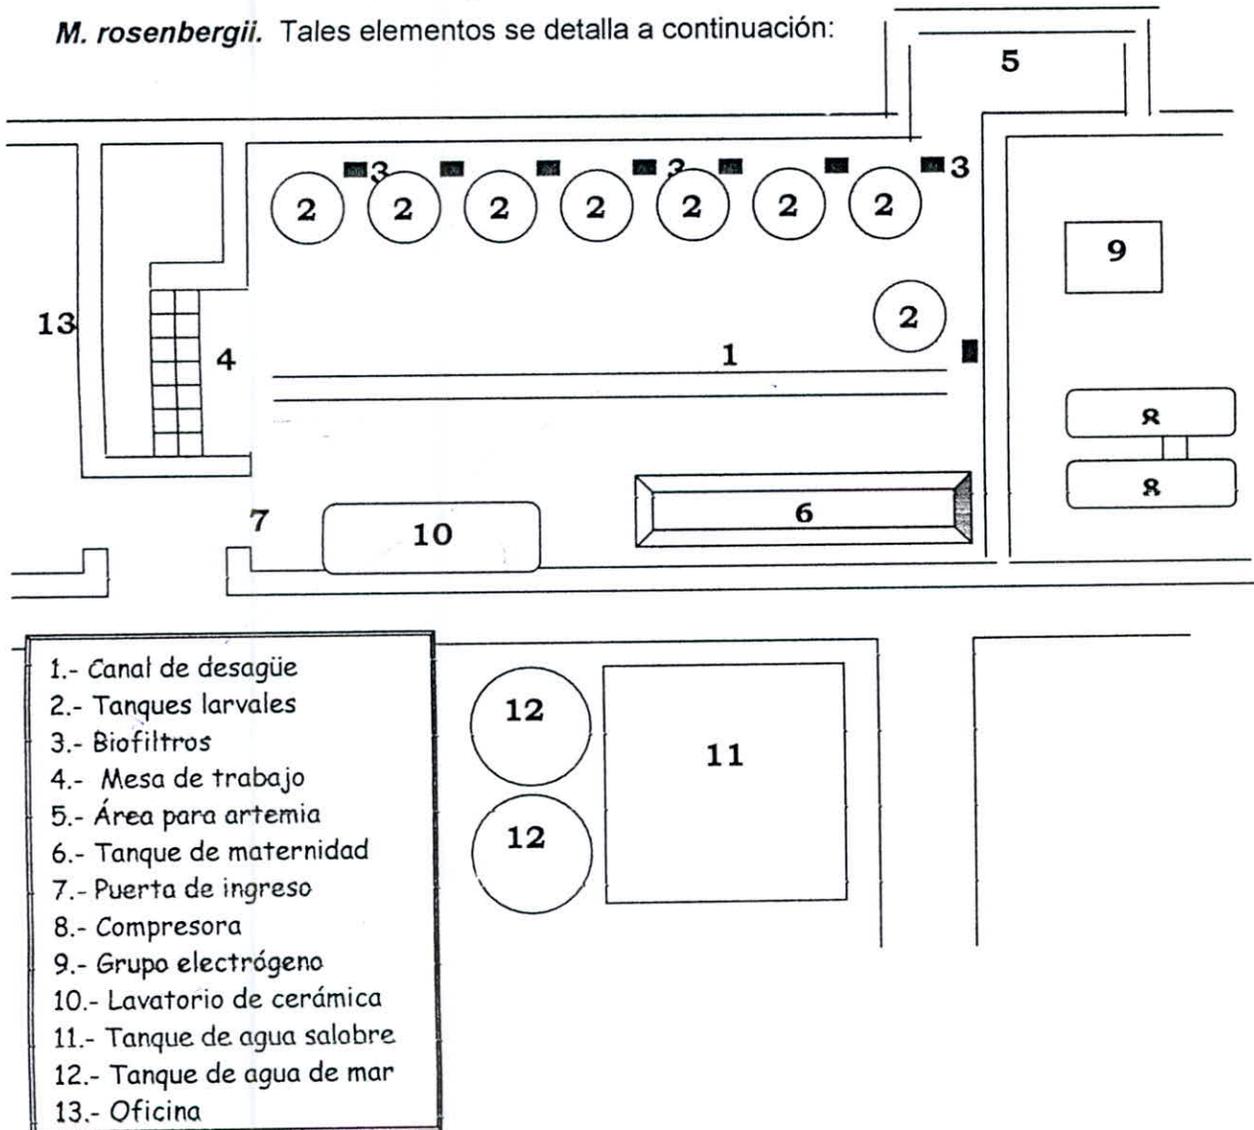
Vista en planta del Centro de Producción de postlarvas (ecloserie) "Carlos Fon Lau".
